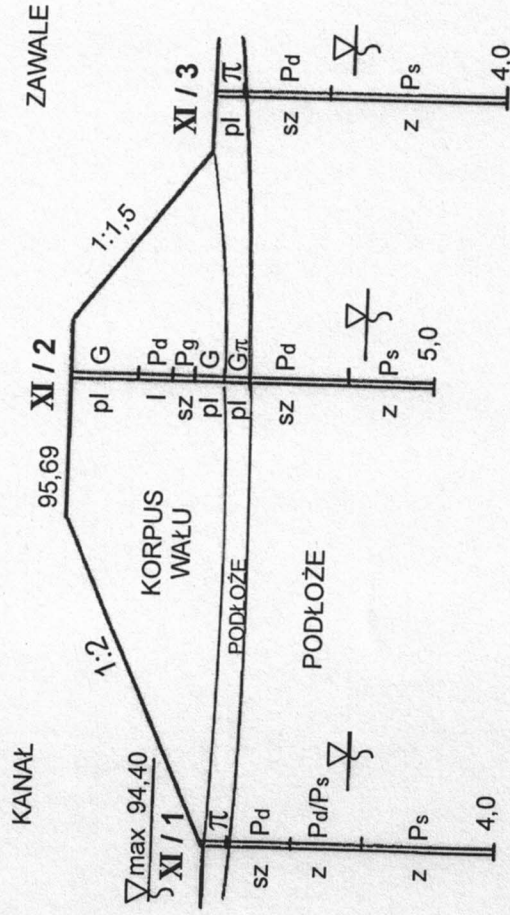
WAŁ PRAWY PRZEKROJE GEOTECHNICZNE
